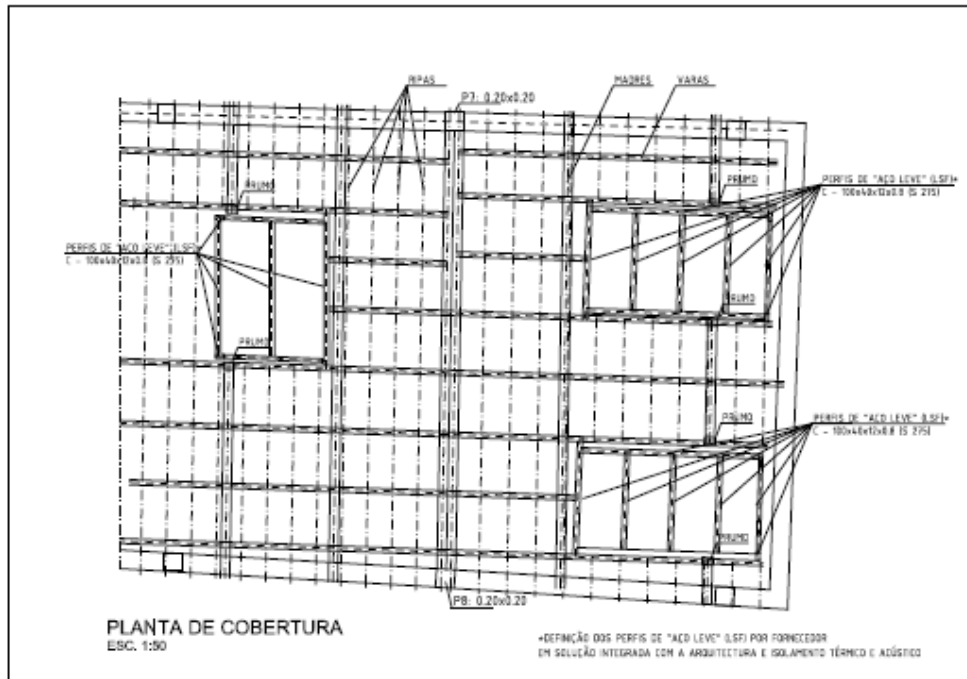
planta da cobertura (Nunes, projeto de estabilidade, 2016)
